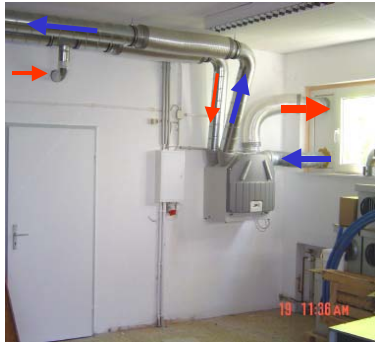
Nachträglich eingebaute Lüftungsanlage mit WRG in einem Büroanbau mit Gewerberaum am Rand der Detmolder Innenstadt
